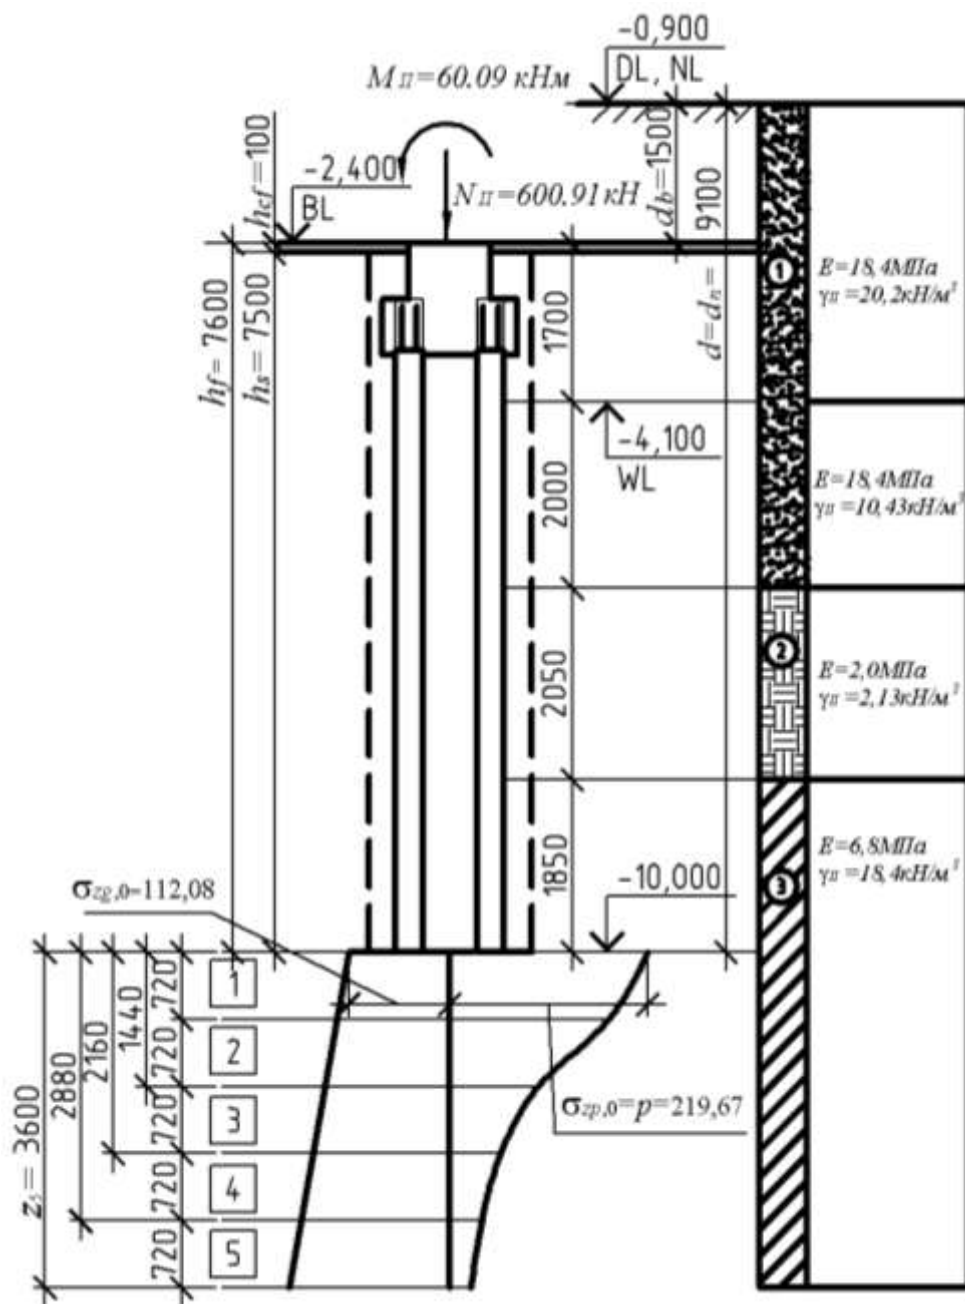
Расчетная схема для определения осадки к примеру 8.2.2.
